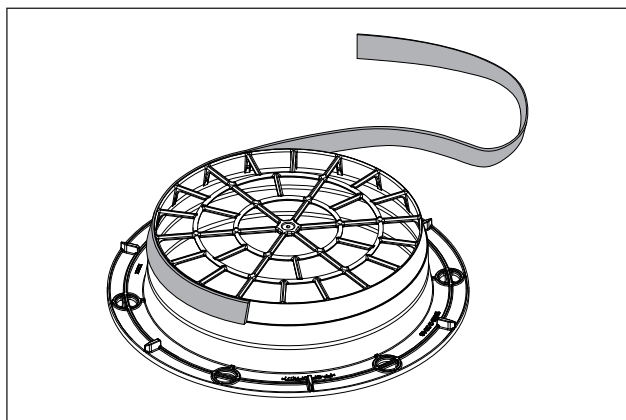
Position på forseglingsstapen til montering med rundrør
